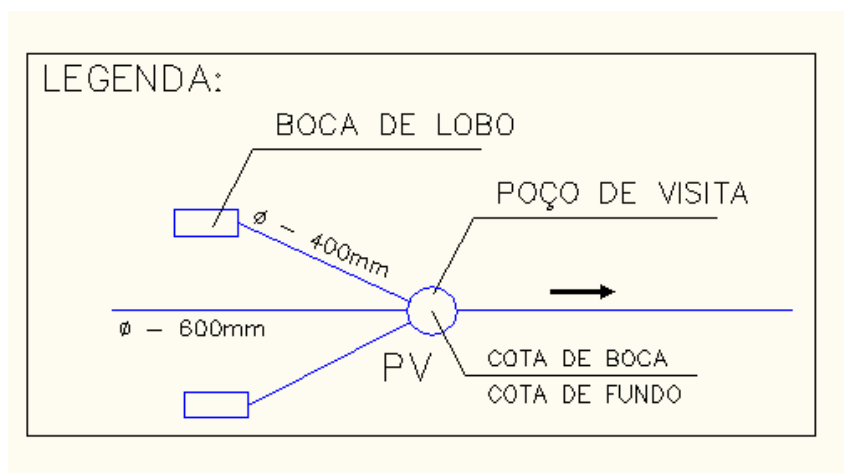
Detalhe genérico das ligações com tubos de concreto com diâmetros de 400 mm e 600mm.
